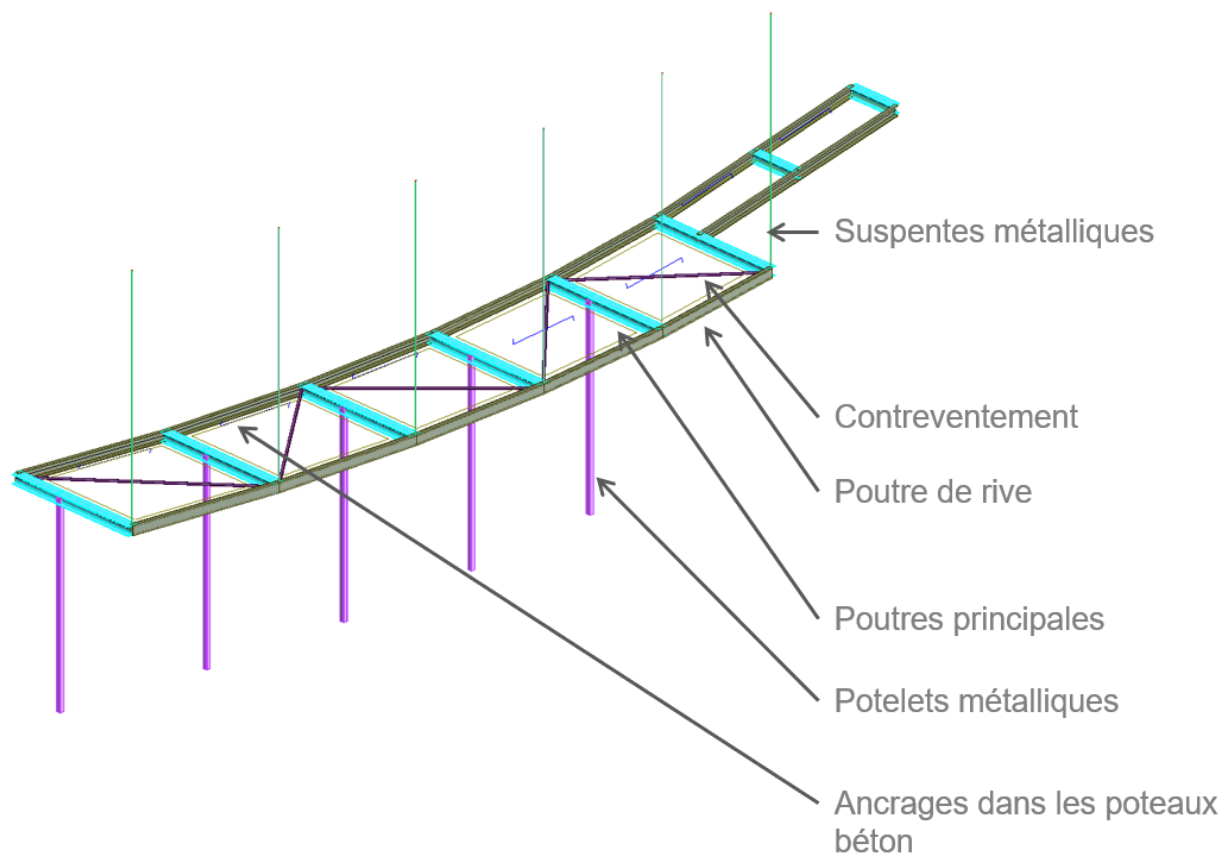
Structure de l'extension de la dalle du foyer haut sur le grand hall
